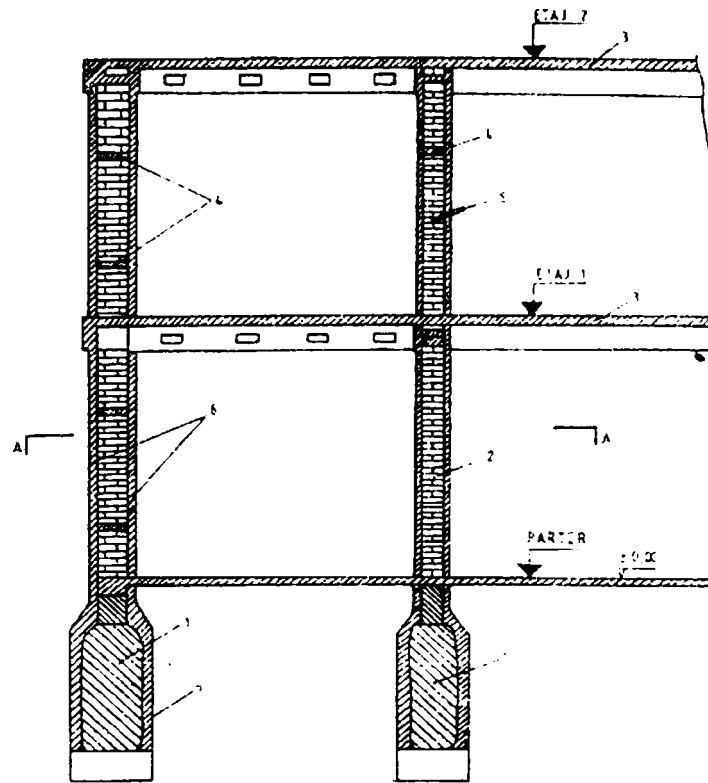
Consolidarea peretilor structurali din caramida prin camasuielei din beton armat pe ambele fete ; 1- fundatie structura ; 2- pereti portanti ; 3- planseu ; 4- gauri in zidarie pentru golurile de legare intre straturile de camasuiala; 5- stut pentru injectare beton ; 6- camasuiala din beton armat .
